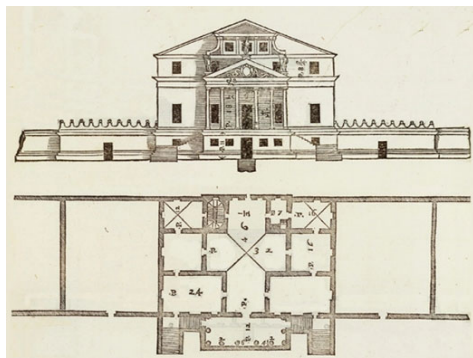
Le plan de Palladio de la Villa Foscari (Palladio, 2002).
